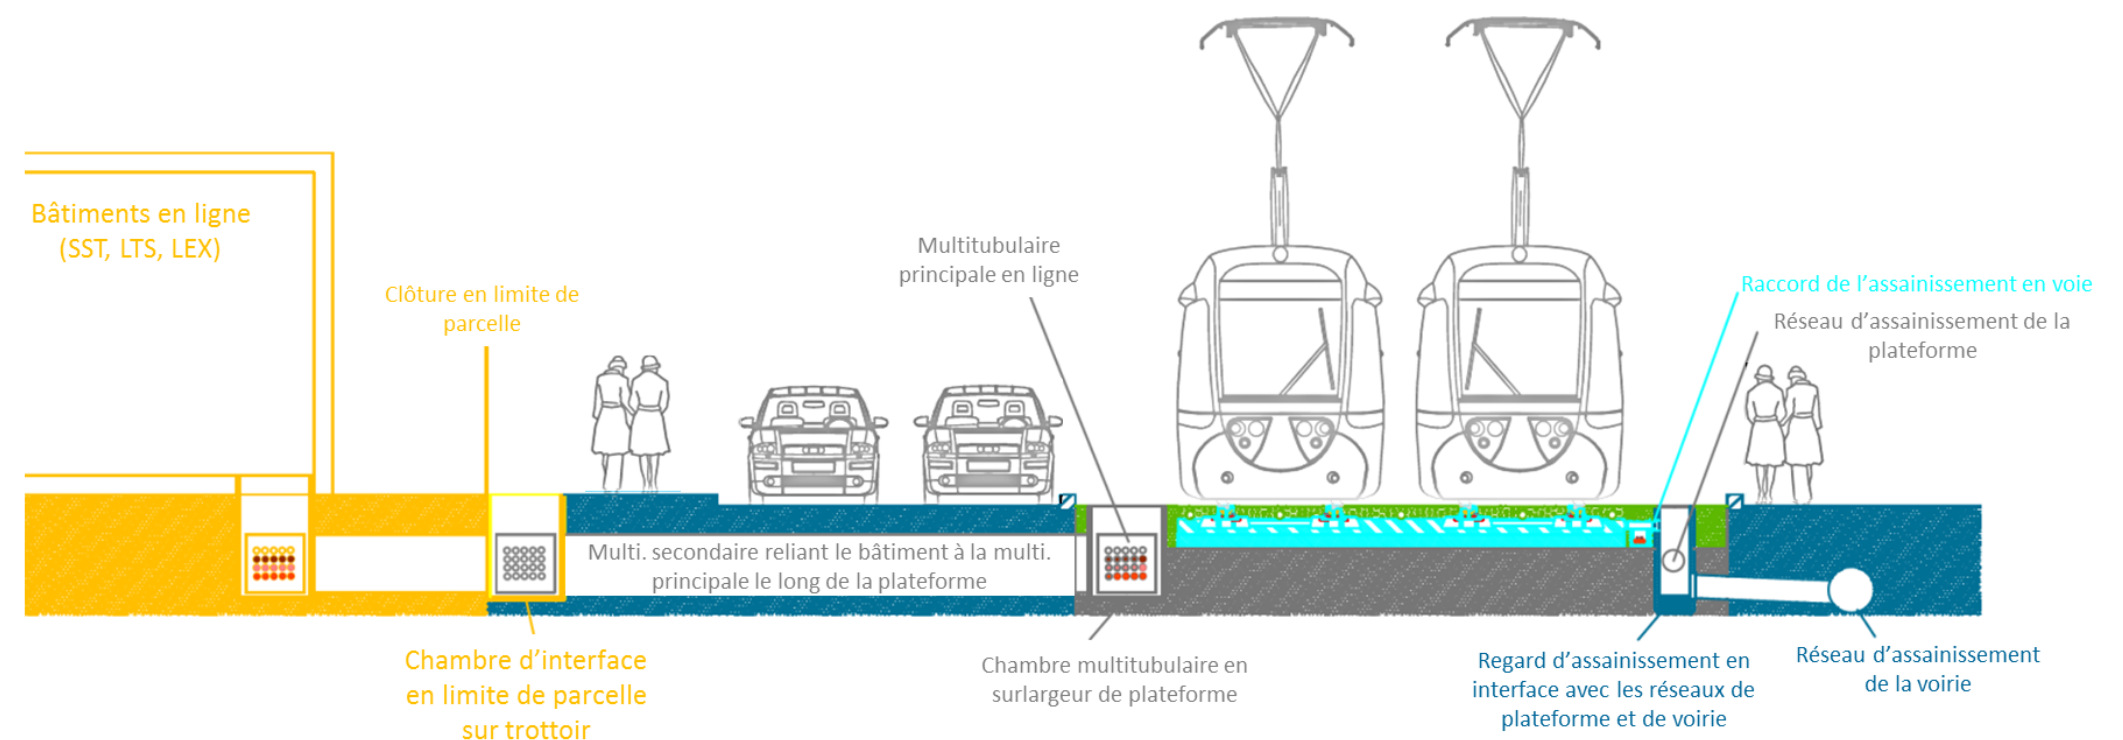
Coupe type d'implantation de multitubulaire et chambres de tirage
